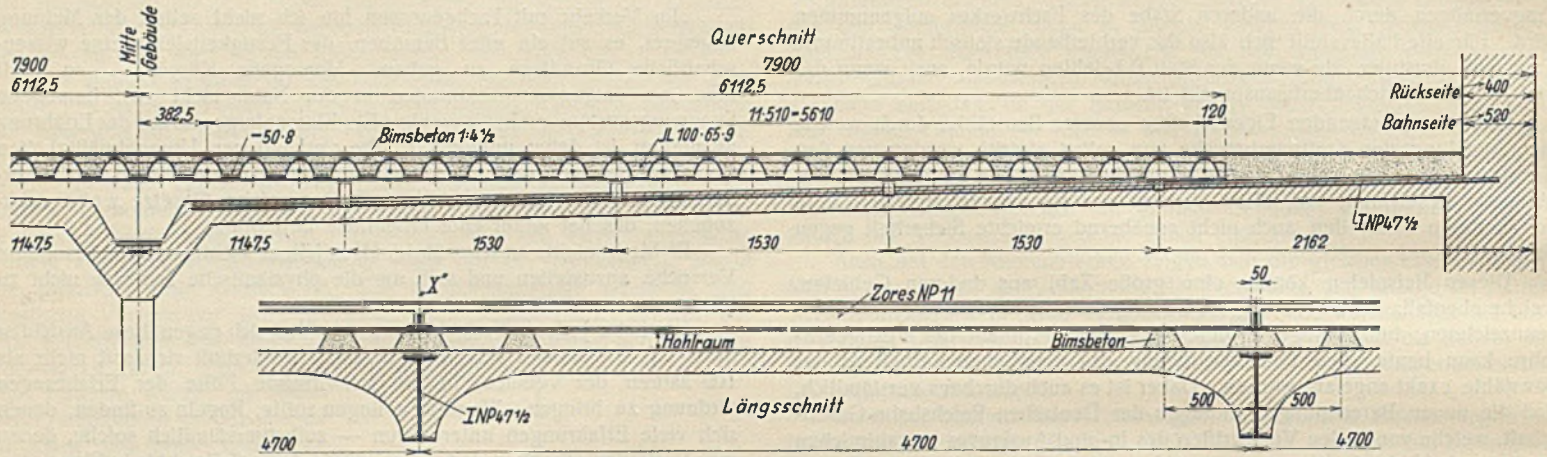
Neue Fußbodenkonstruktion über der alten Dachdecke.
